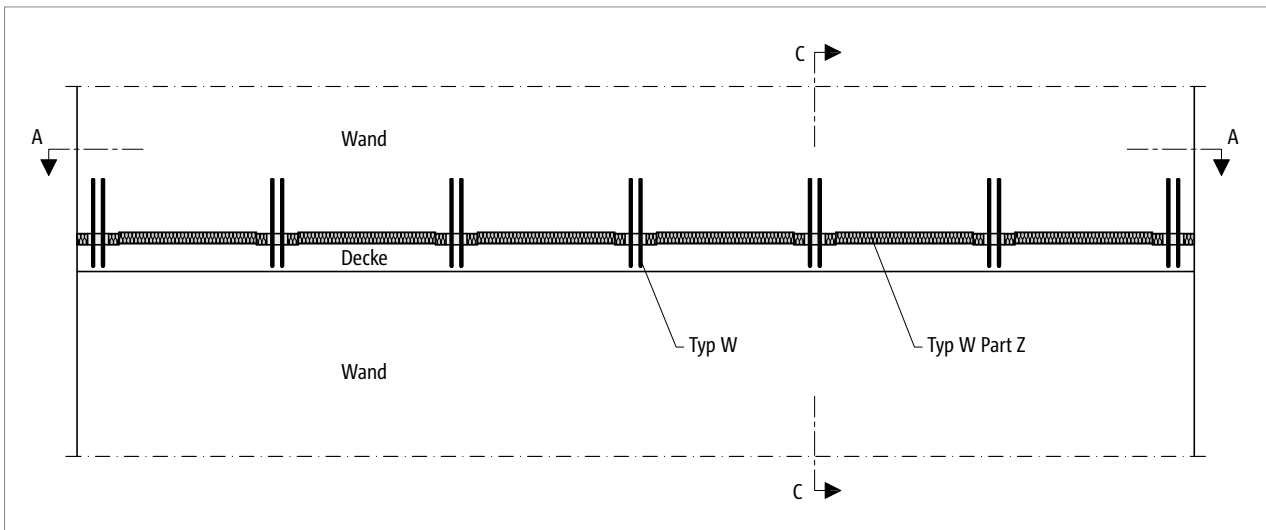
Schöck Sconnex® Typ W: Anschluss zwischen Decke und aufgehender Wand – Einbau am Wandfuss
